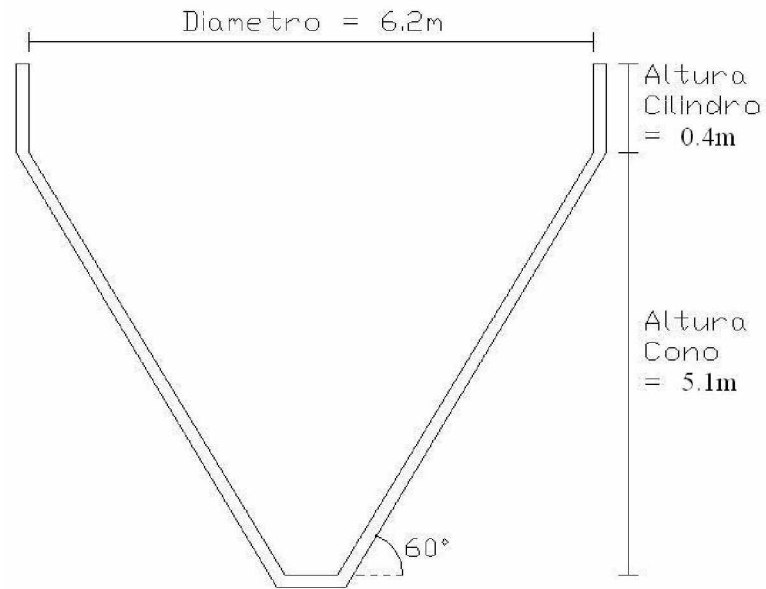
Esquema del sedimentador secundario de la Planta N°3
